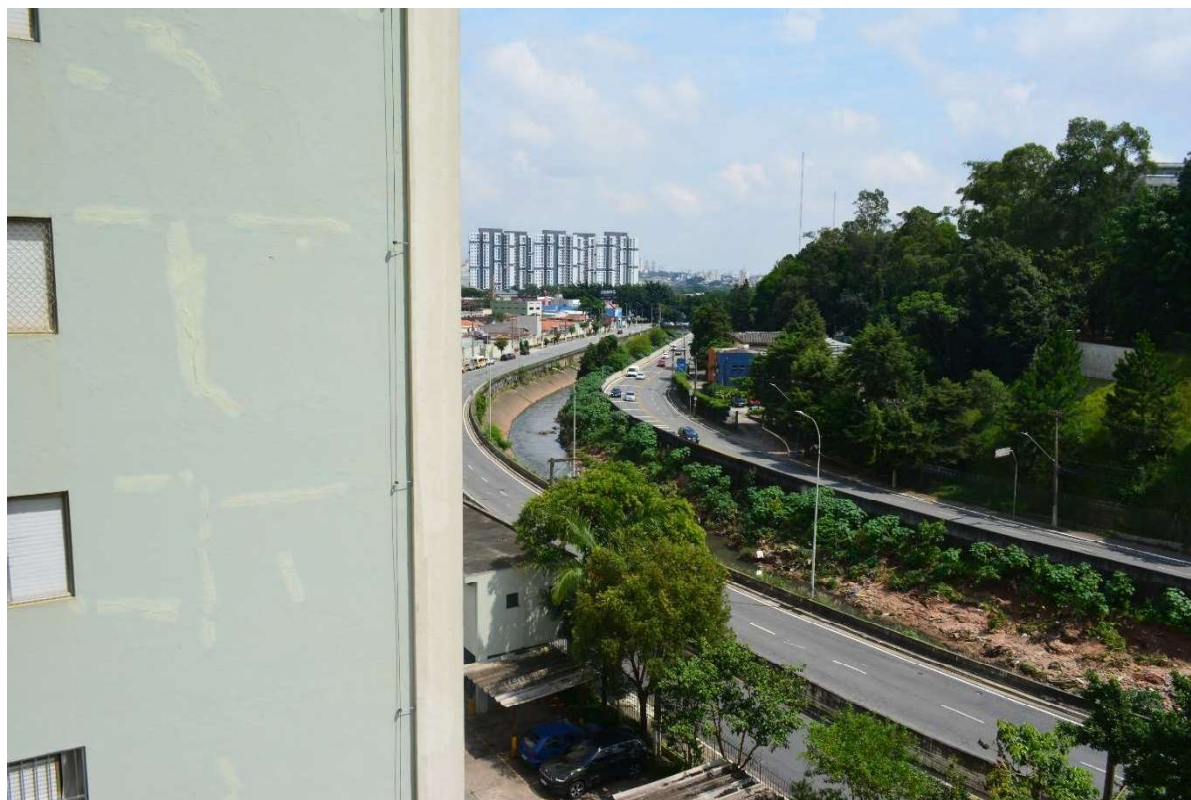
VISTA DA JANELA DO DORMITÓRIO 1.
